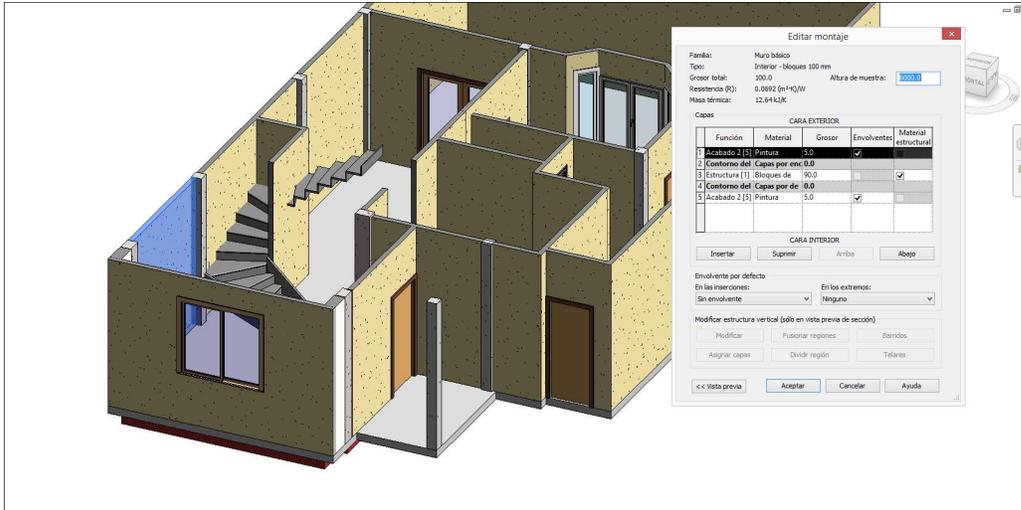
Vista de paredes y columnas levantas en Revit, y ventanas de propiedades de elementos
